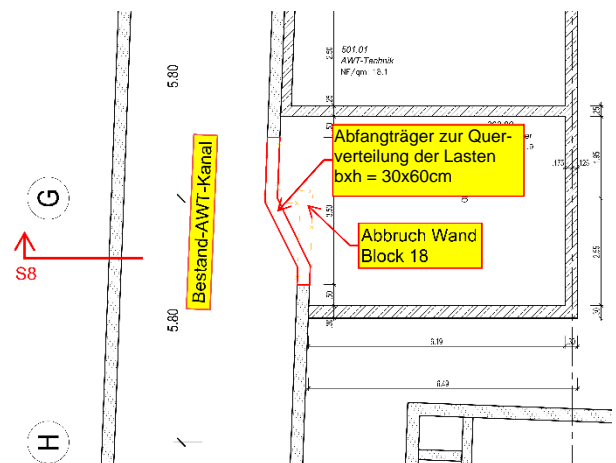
Grundriss UG, Auszug aus
